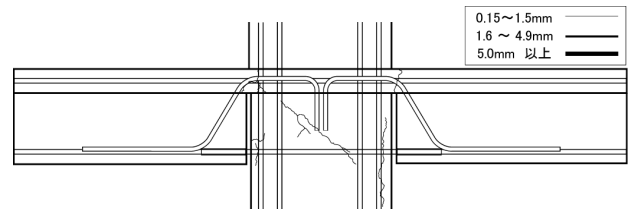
補修の対象となるひび割れ状況 (SB-1)
